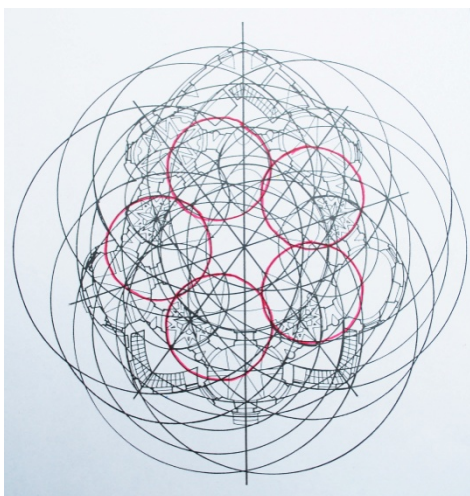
geometrická osnova vytyčení půdorysu stavby
